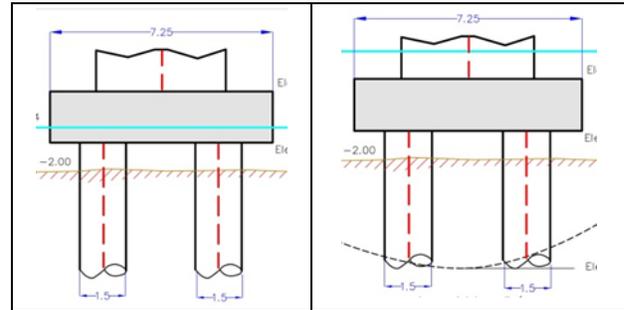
Zapata y Pilotes expuestos al agua. Escen. 1 y 2.
